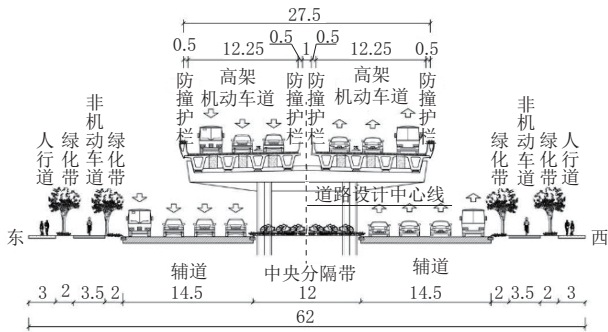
子项方案 A 桥梁横断面示意图(单位:m)
